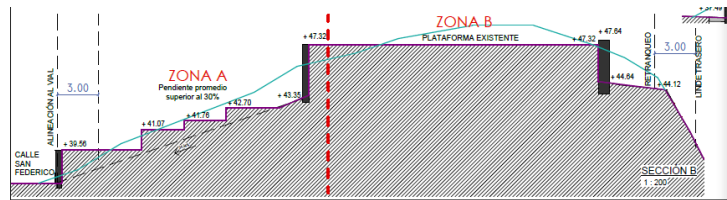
Sección transversal de parcela indicando Zonas A y B
